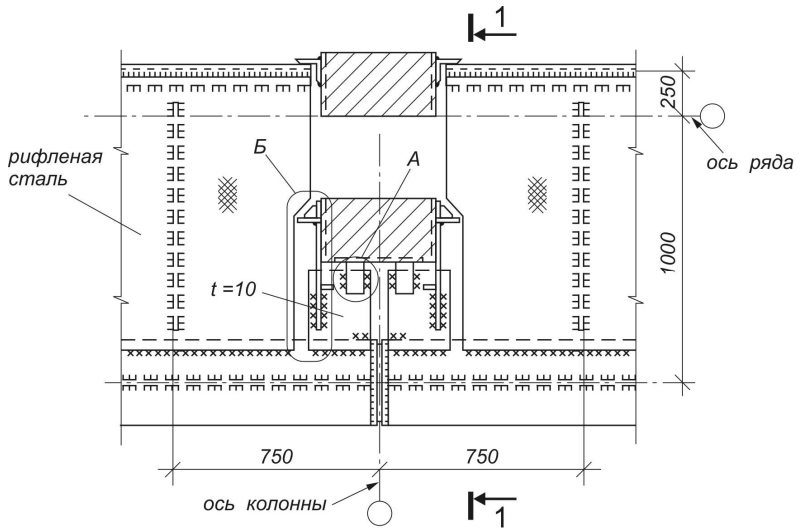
Сопряжение разрезных подкрановых конструкций в уровне верхнего пояса при тормозной балке на ж/б колонне
